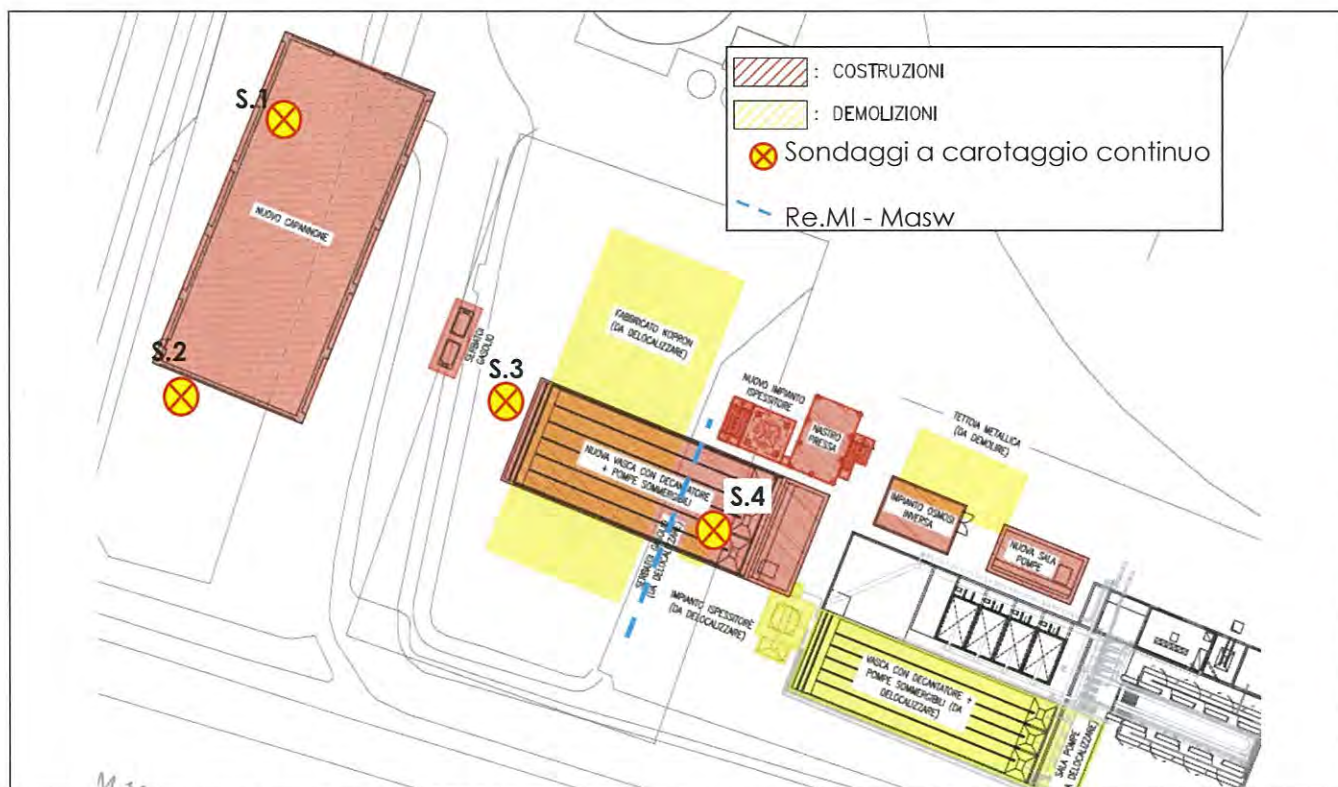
ubicazione indagini su planimetria schematica di intervento demolizioni/ricostruzioni
